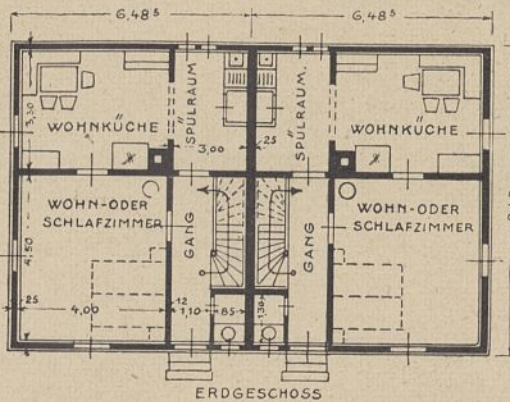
u. 53. Grundrisse zu Abb. 51.
